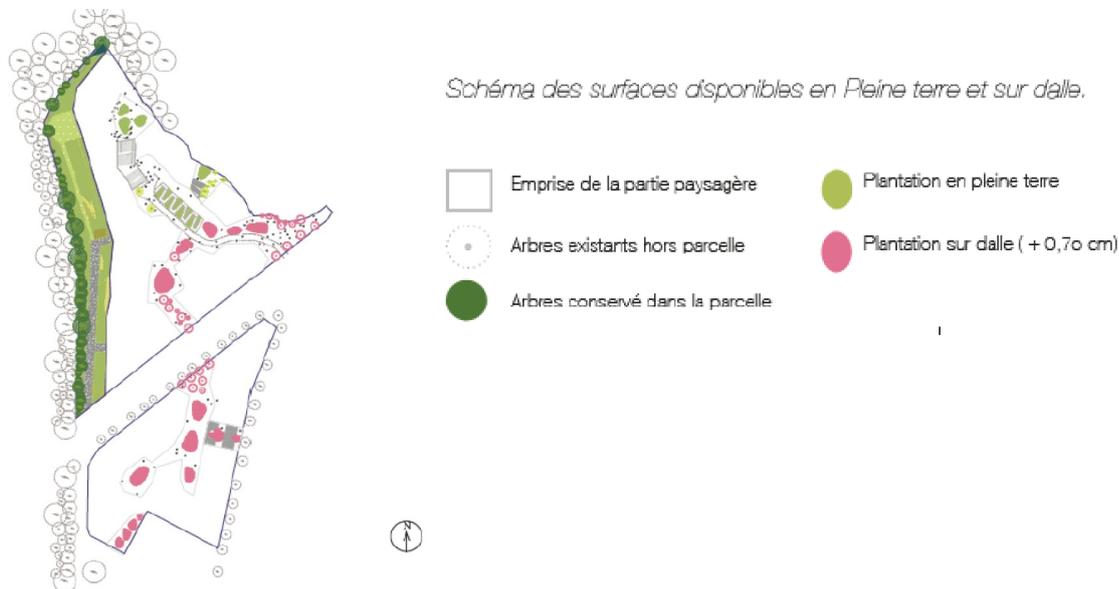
Schéma des surfaces disponibles en pleine terre et sur dalle, rez-de-chaussée / rez-de-jardin (p. 67)
